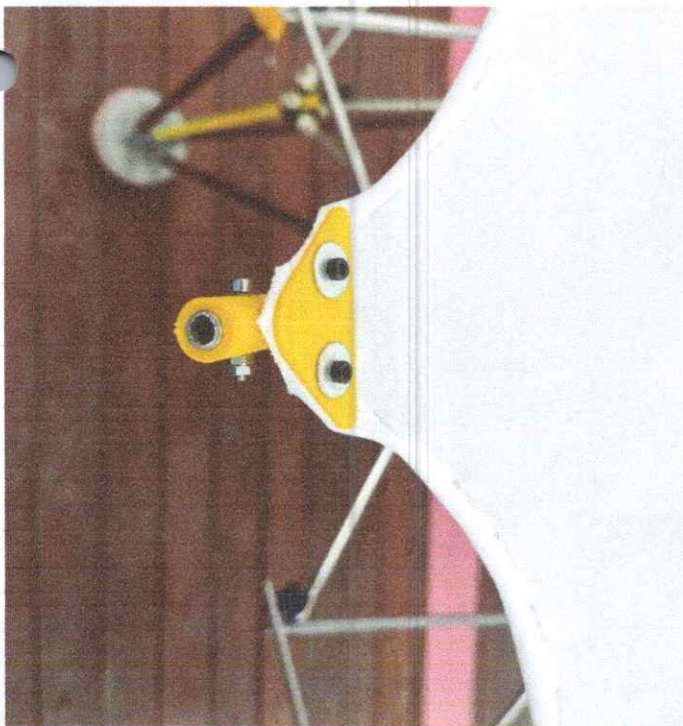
y 22.2 Detalles de ensamblaje de cubierta a estructura plegable
